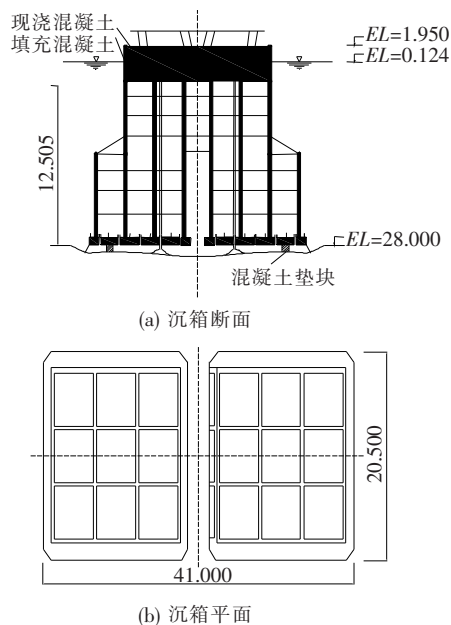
沉箱断面及平面(编号 LOT2-P5)(单位:m)
